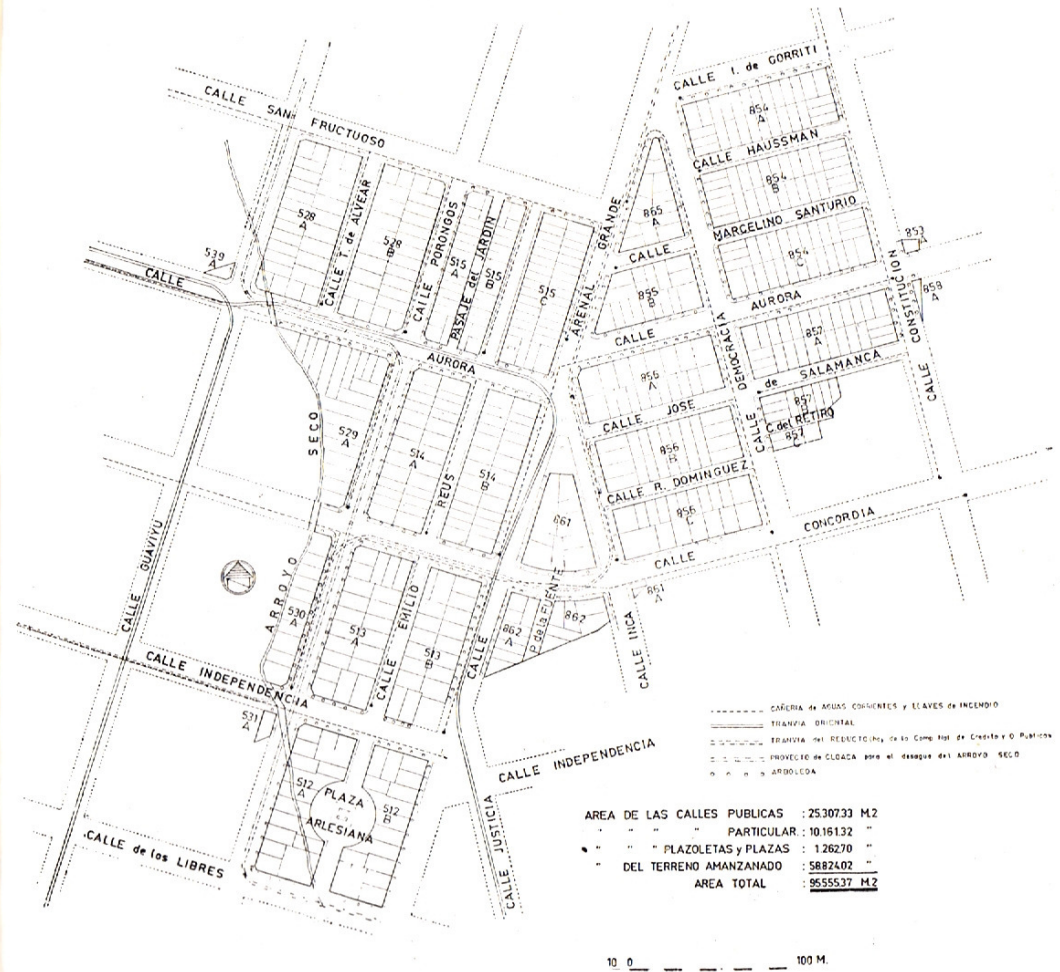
Barrio Villa J. M. Muñoz — Planta.
